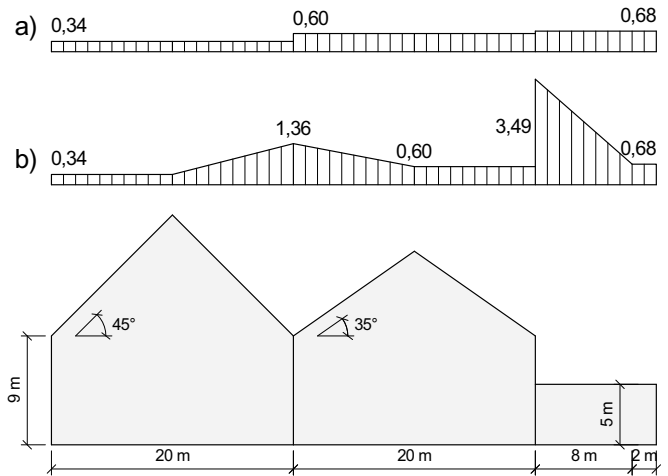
Beispielhafte Schneelasten auf aneinanderggebauten Dachflächen in der SLZ 2 auf 280 m Höhe. Fall a) ohne und Fall b) mit Verwehungen.
